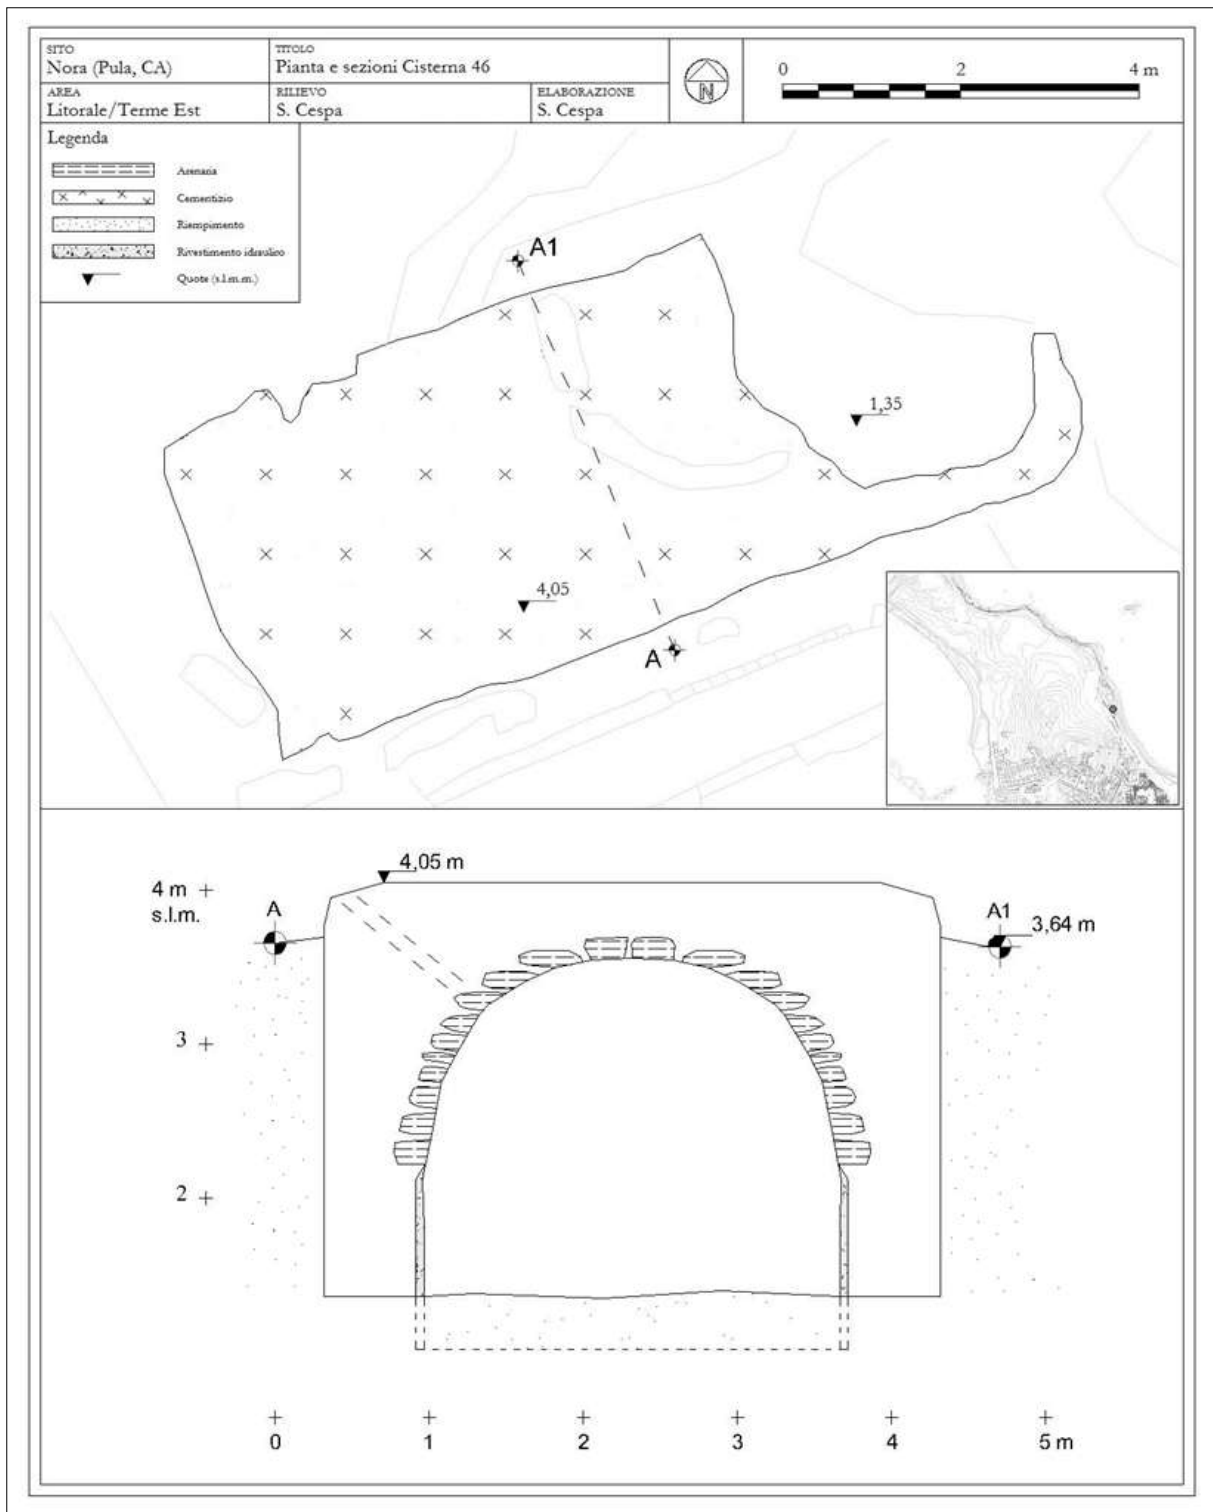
Pianta e sezione indicativa della cisterna/serbatoio 46 (elaborazione dell'autore).
